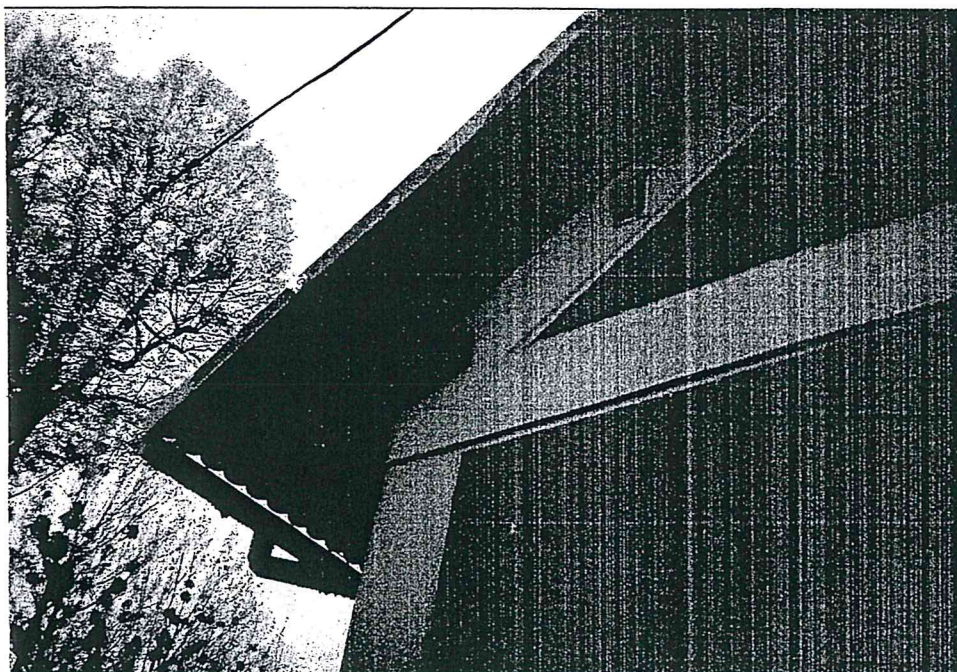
widok elewacji północnej oraz fragment elewacji wschodniej
